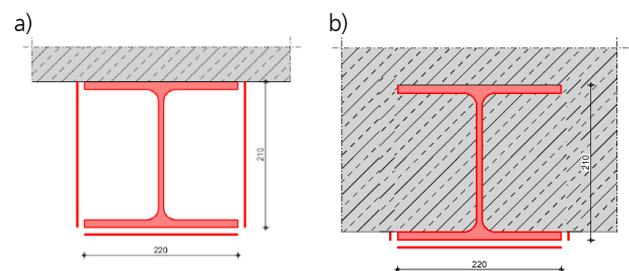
a) Brandfall – Querschnitt mit dreiseitiger Beanspruchung
